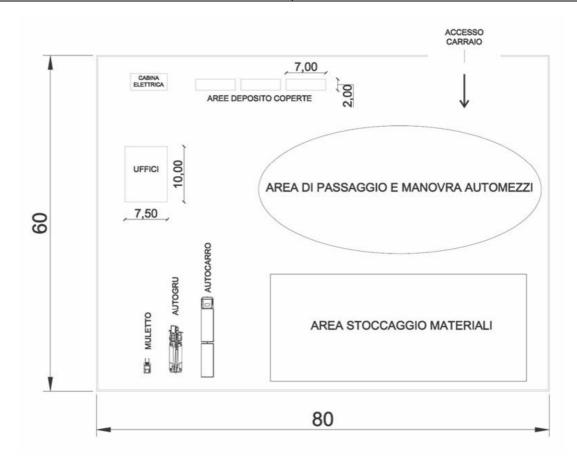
Planimetria dell'area centrale di cantiere - misure indicative
